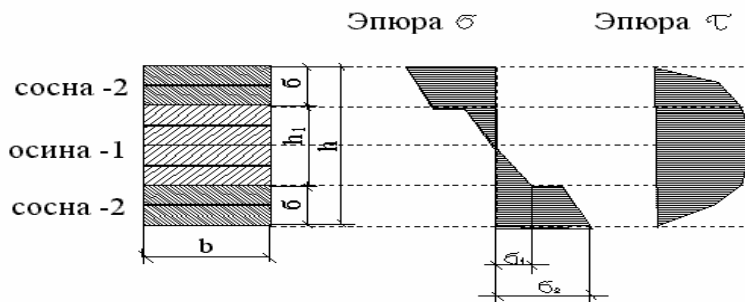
Схема комплектования клееной заготовки с эпюрами возникающих напряжений
